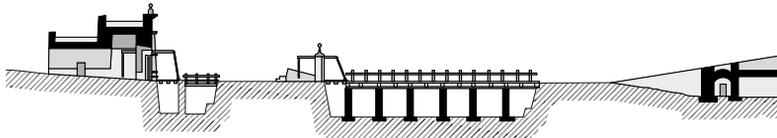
Perfil seccionado 9-10 / Elaboración propia.
